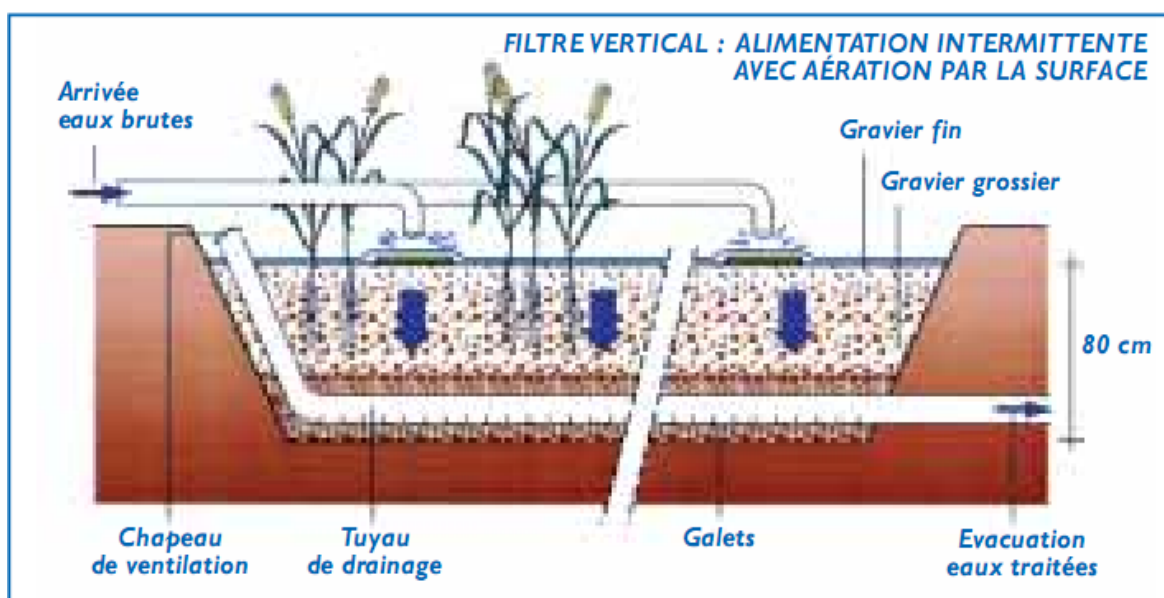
Coupe transversale d'un filtre planté à écoulement vertical
